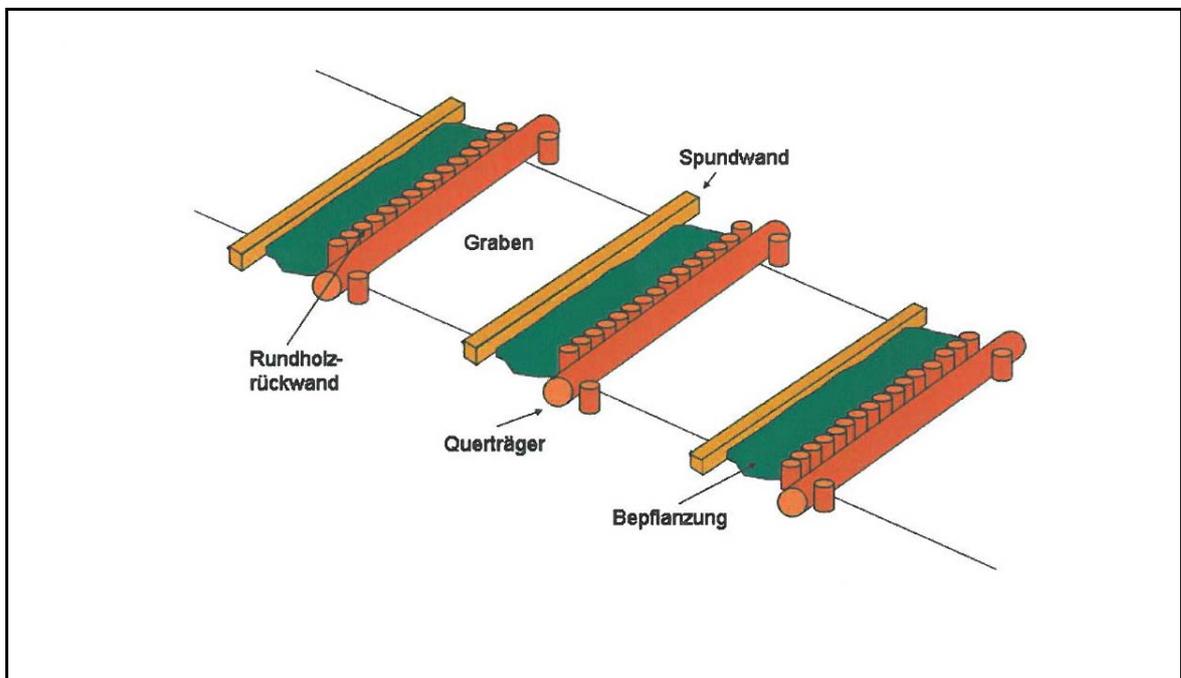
Oberflächliche Ansicht dreier Sperren mit senkrecht stehender Rundholrückwand.
